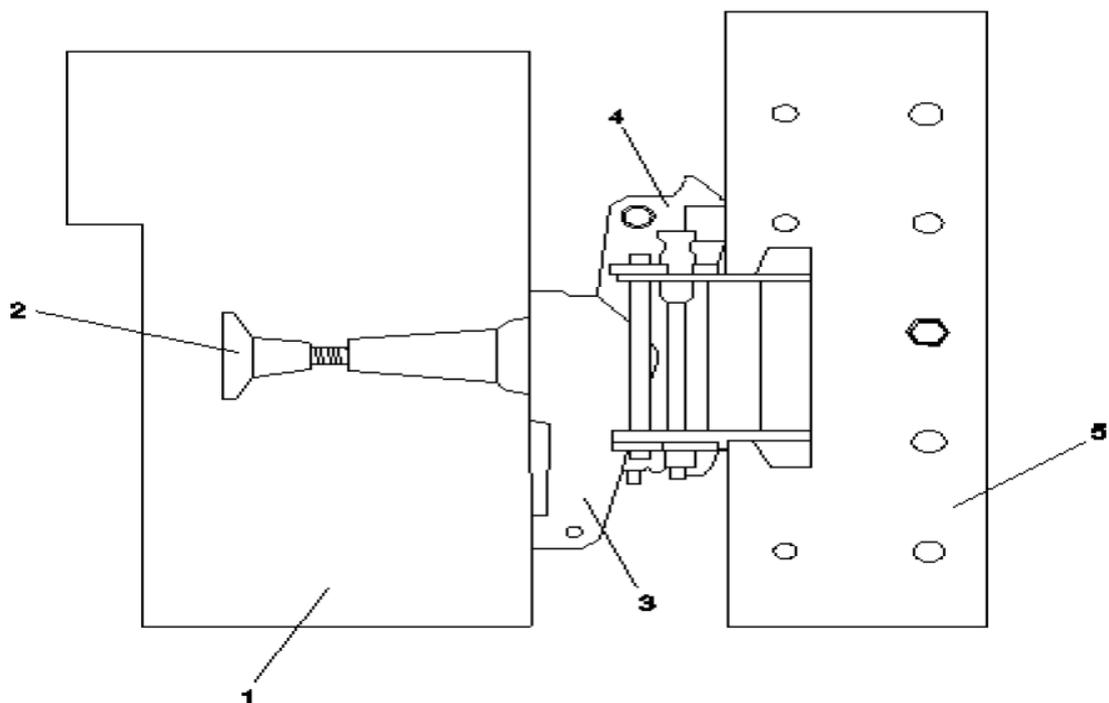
Схема крепления направляющих балок подъемно-переставной опалубки к монолитной стене 1 – монолитная стена; 2 – анкер; 3 – навесной башмак; 4 – гравитационный механизм; 5 – направляющая балка
